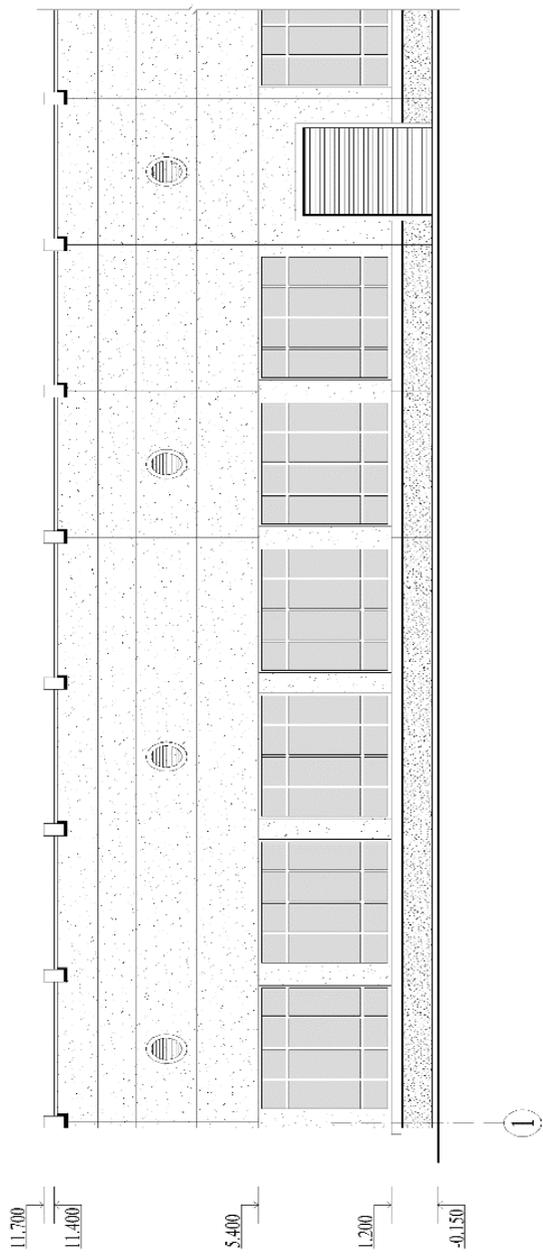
Пример фрагмента фасада производственного здания с применением трехслойных стеновых панелей горизонтальной разрезки
